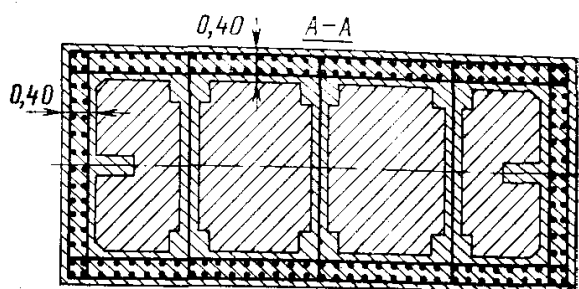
Усиление опоры железобетонной оболочкой: 1 – железобетонные связи между стенками оболочки; 2 – каменная кладка опоры; 3 – железобетонная оболочка
